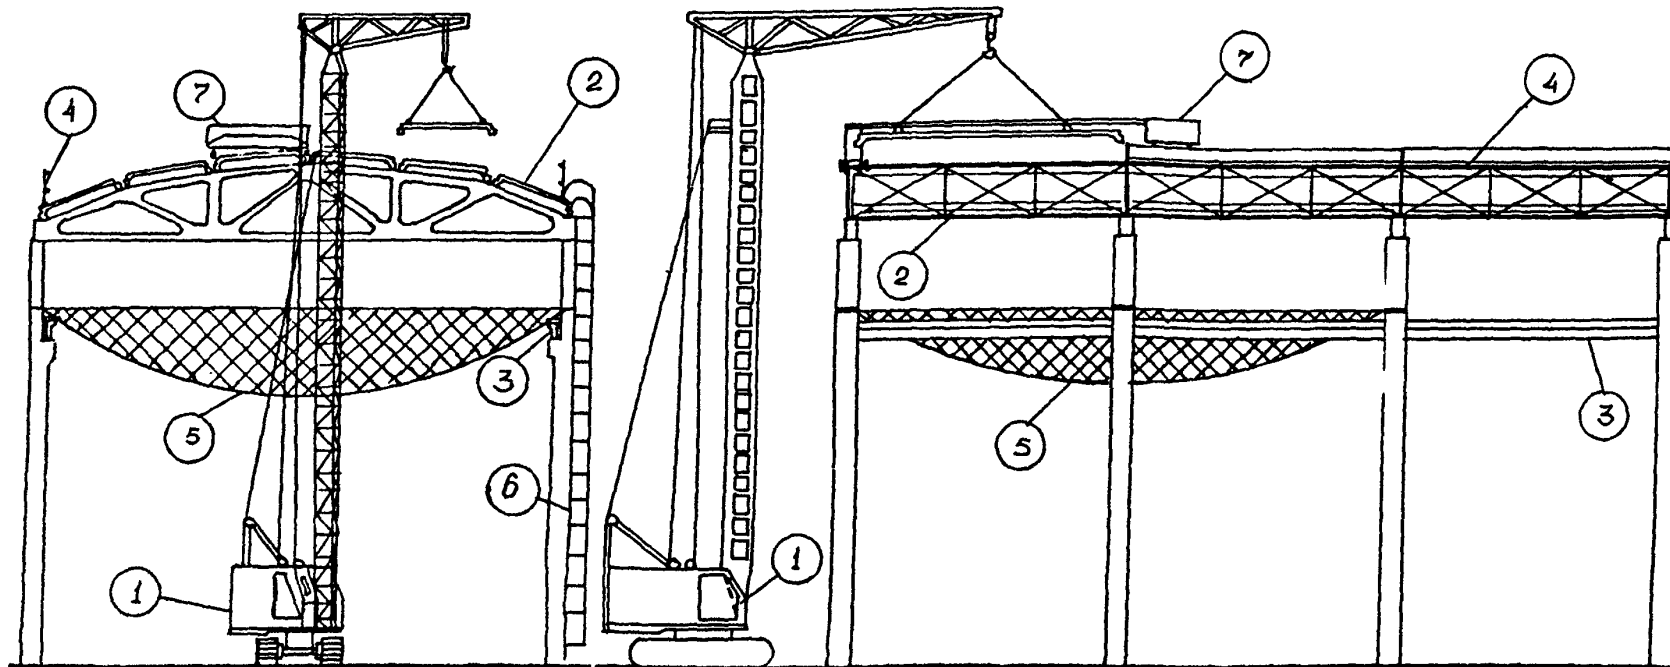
Рис. II. Монтаж плит покрытия при возведении одноэтажного промышленного здания с использованием средств безопасности
